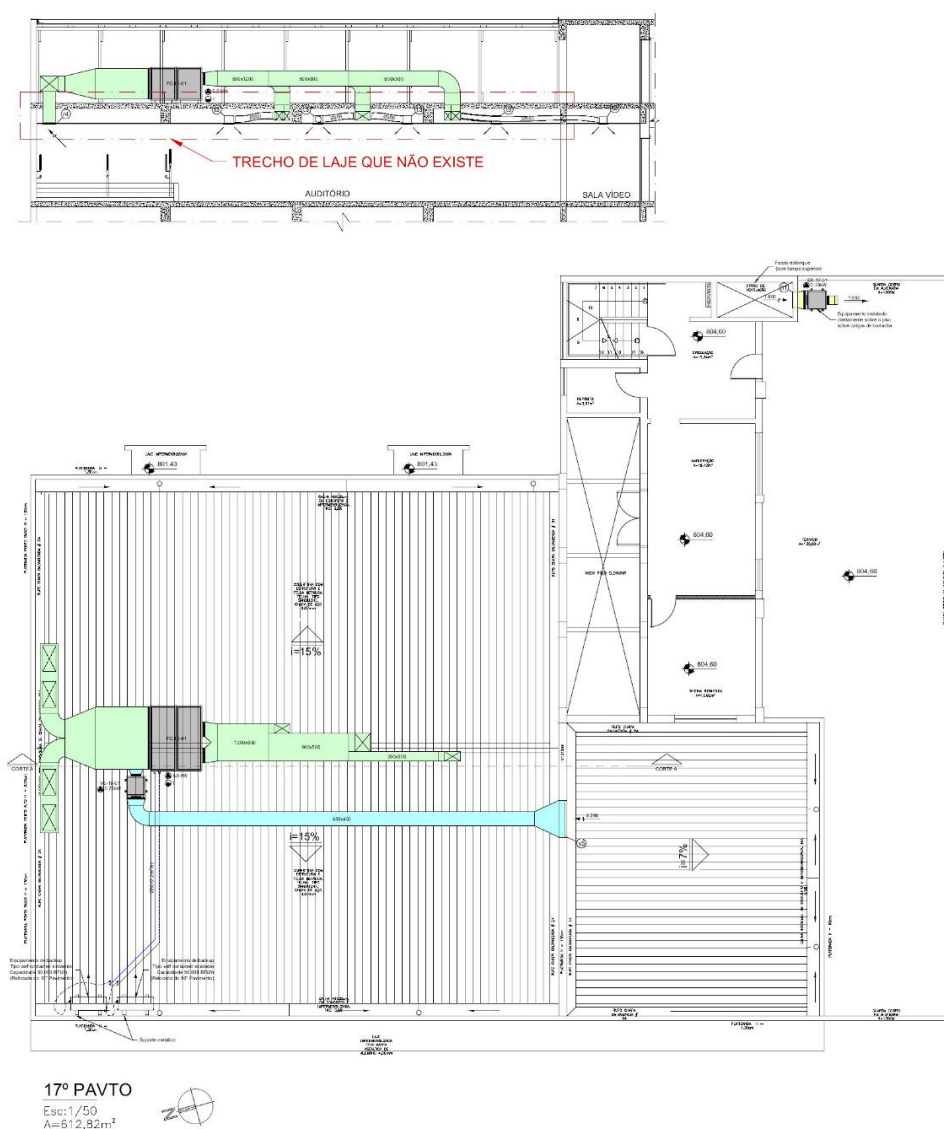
Projeto de climatização 16º e 17º pavimentos – laje não existente.
